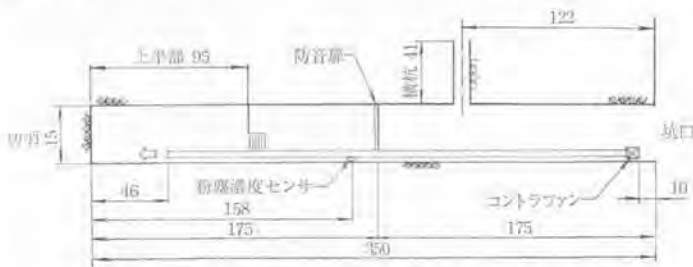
トンネル現況および換気設備の設置状況（平面図：単位 m）
